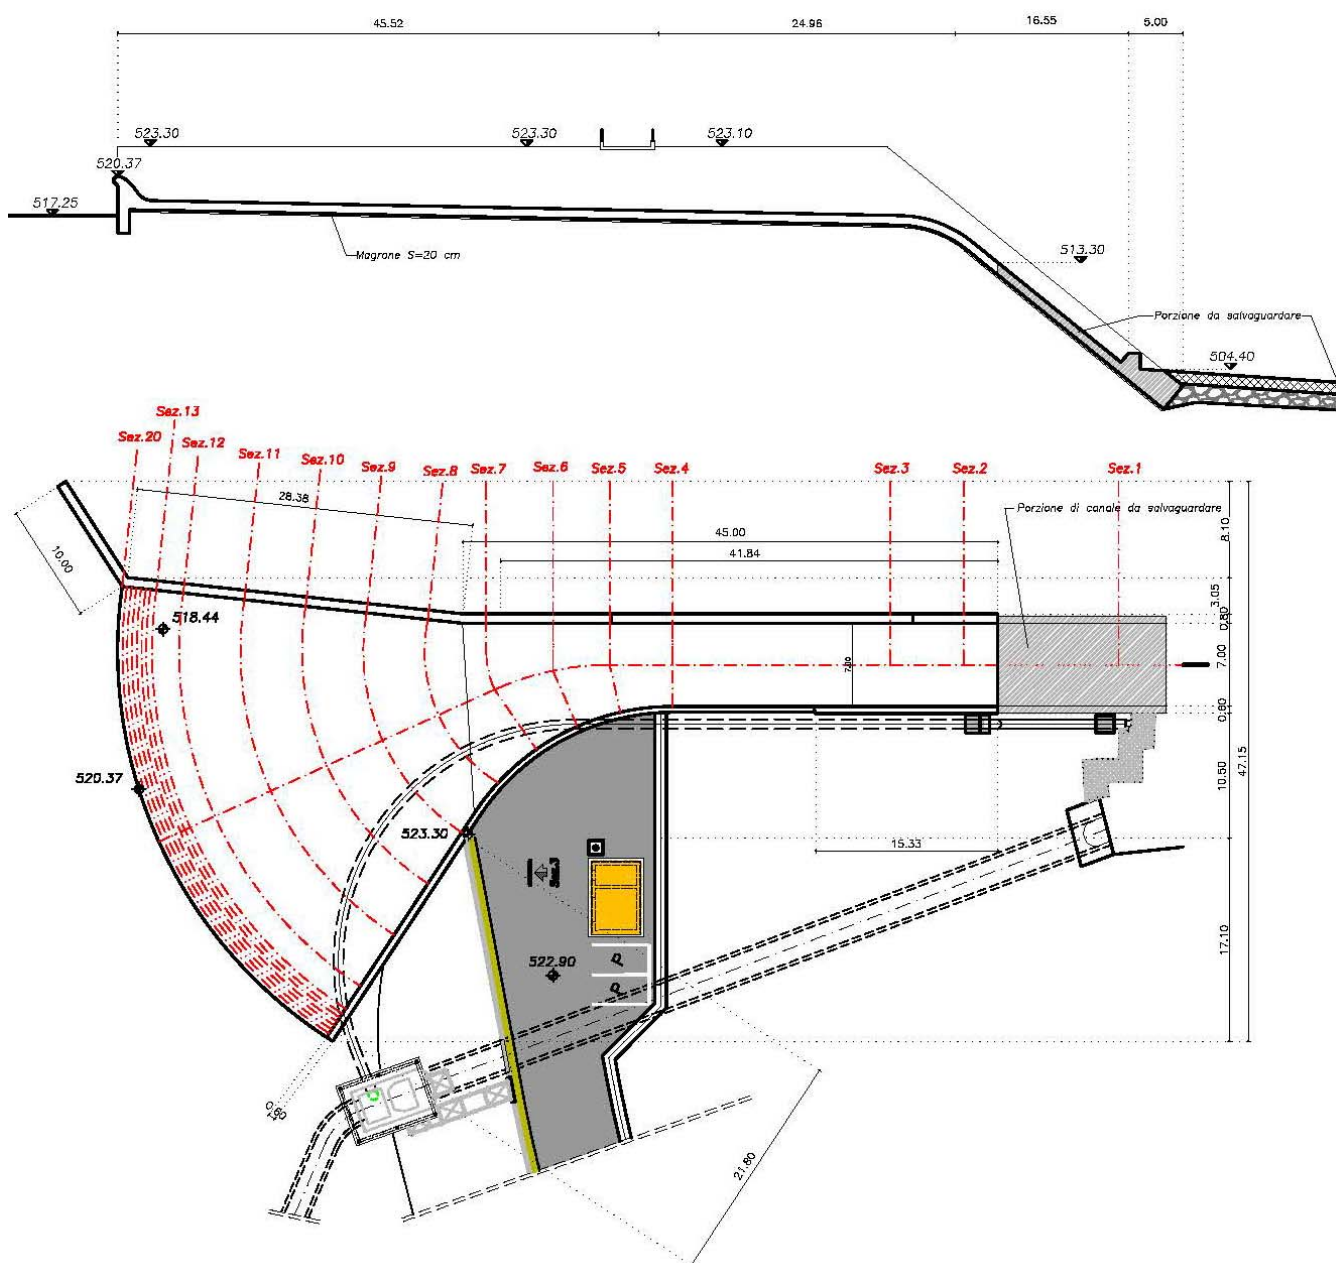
Sezione longitudinale e planimetria dello scarico di superficie in progetto, con individuazione delle sezioni trasversali utilizzate per la modellazione idraulica
